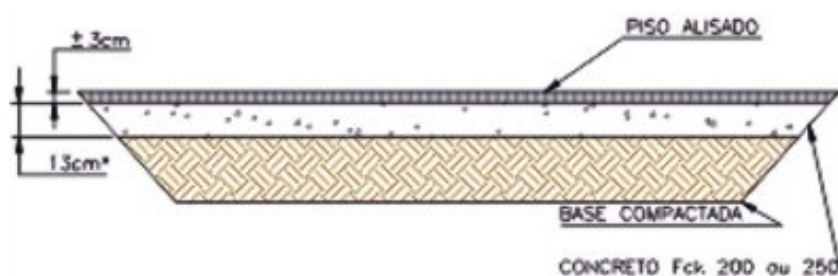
Corte esquemático do piso em concreto (Fonte: ROCHE, 2003)
